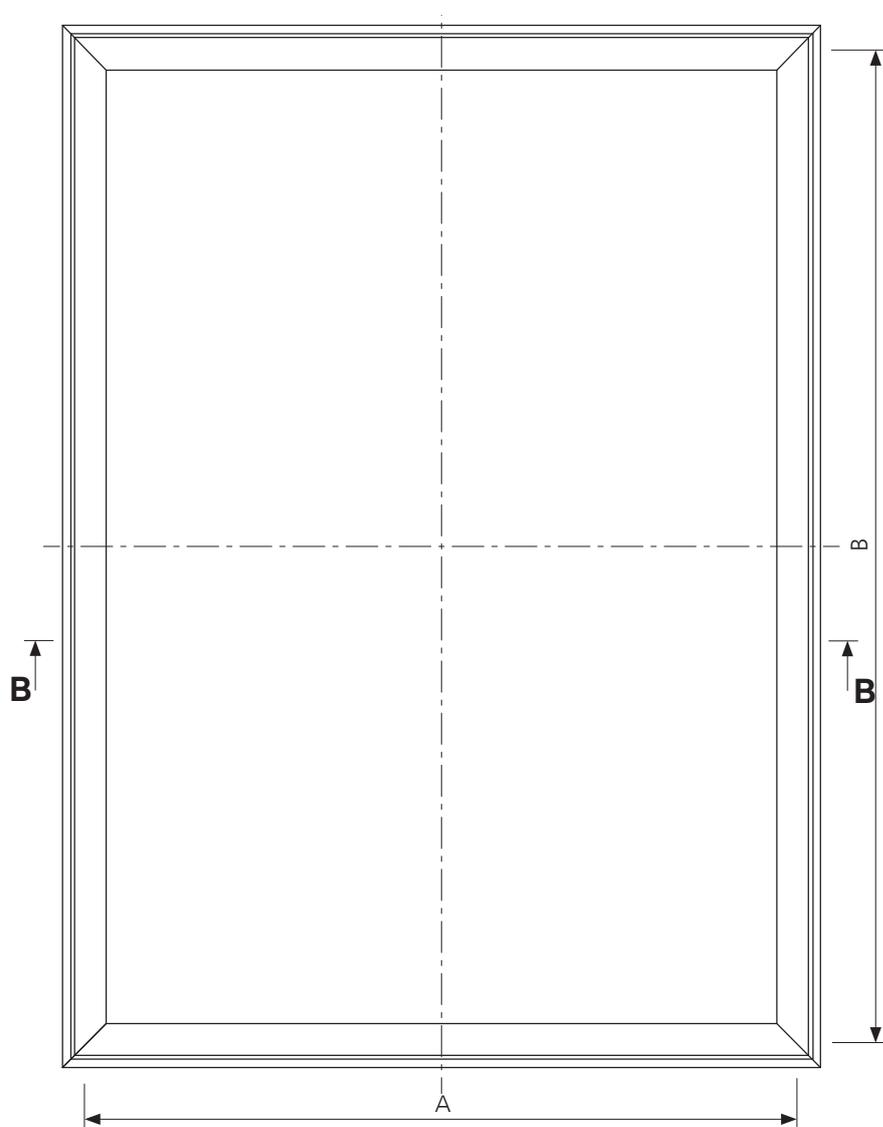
Vue de dessus du lanterneau fixe mcr ULTRA THERM NG-A
